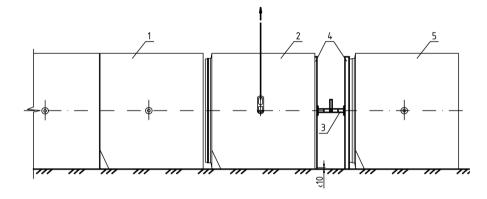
Монтаж тяжелых труб с закладными анкерами.
